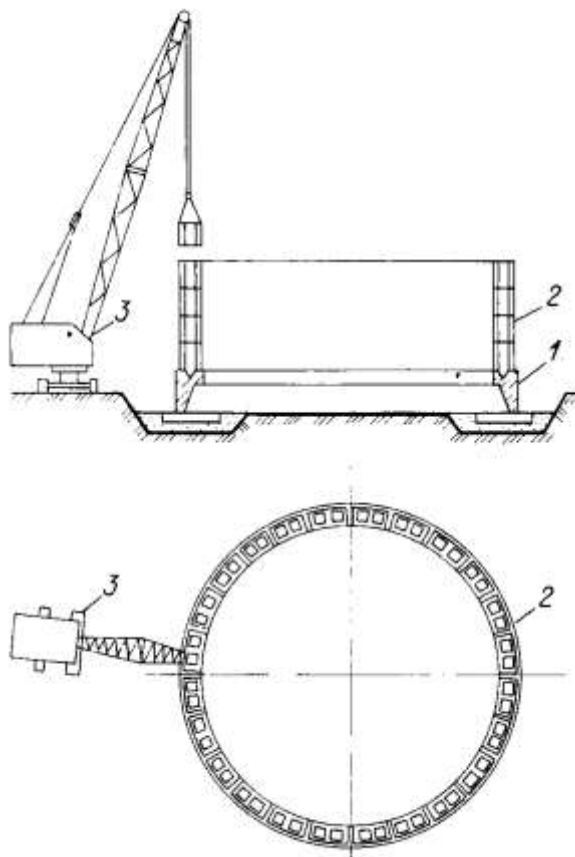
Монтаж колодязя із пустотілих блоків, що заповнюються монолітним бетоном:
